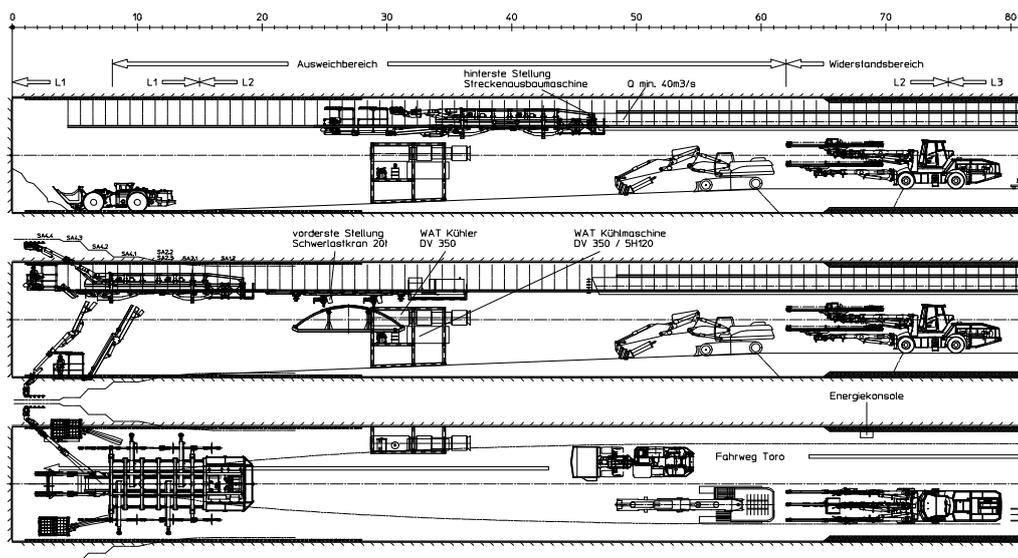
Layout der Installationen für den Vortrieb im druckhaften Gebirge des Gotthard-Basistunnel – Teilabschnitt Sedrun.
